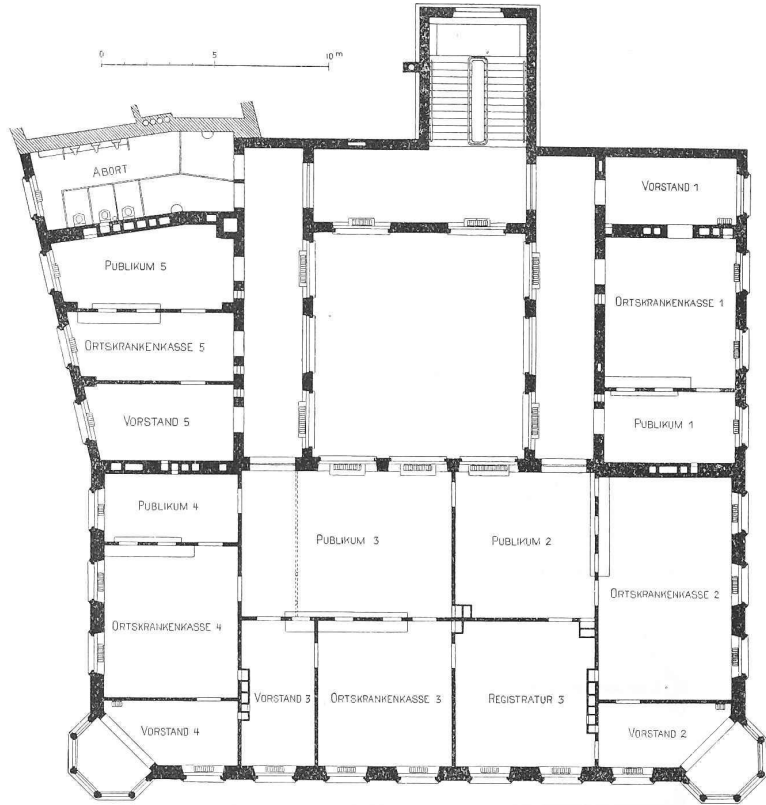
Grundriss vom III. Obergeschoss. — Masstab 1 : 300.
